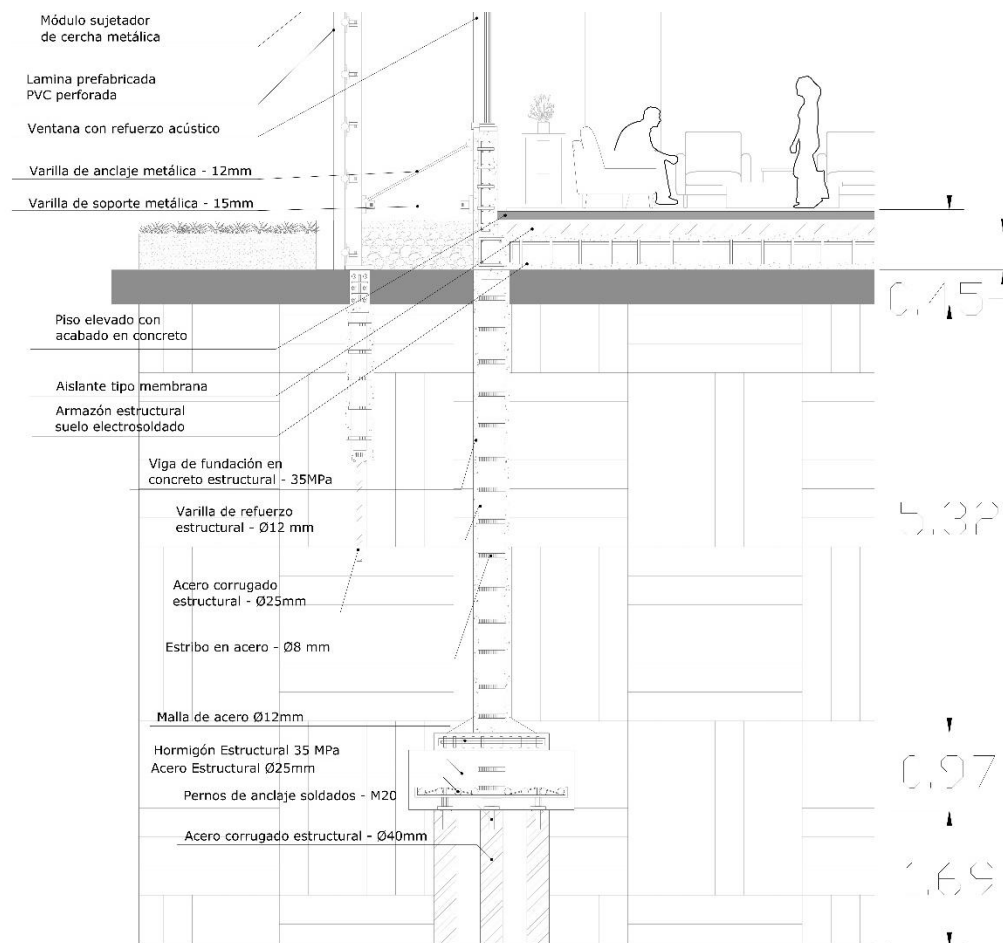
Detalle de corte fachada de proyecto principal, evidenciando la estructura interna de la cimentación con pilotes y el resto de la edificación. Foto propia (2025).
